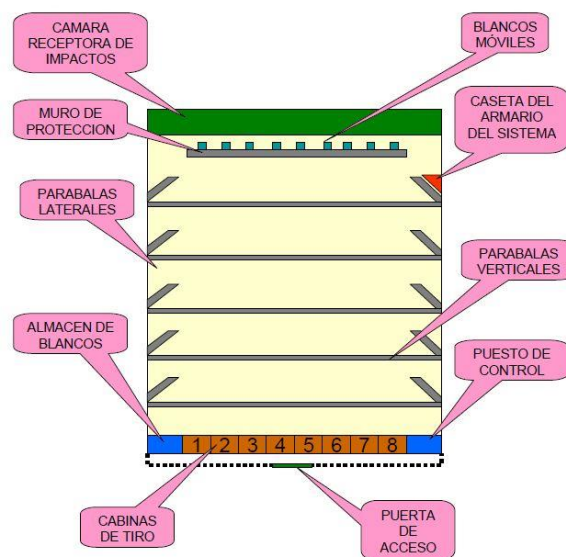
Croquis de la galería de tiro. Fuente: Plan de evacuación de la galería de tiro
